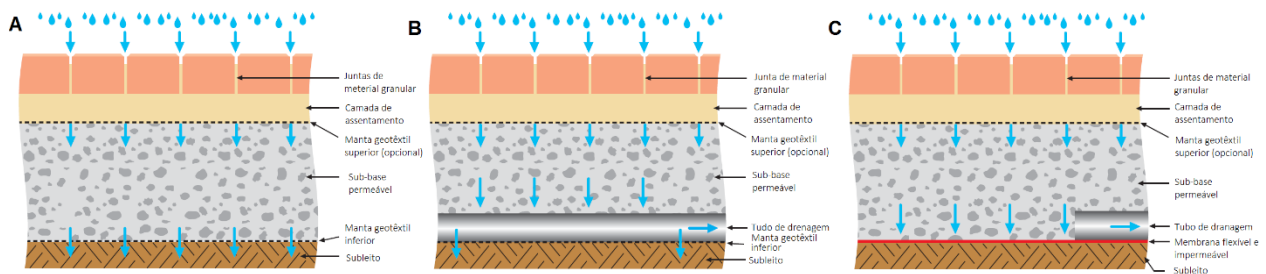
Tipos de pavimentos permeáveis: A Infiltração total, B parcial e C sem infiltração.
